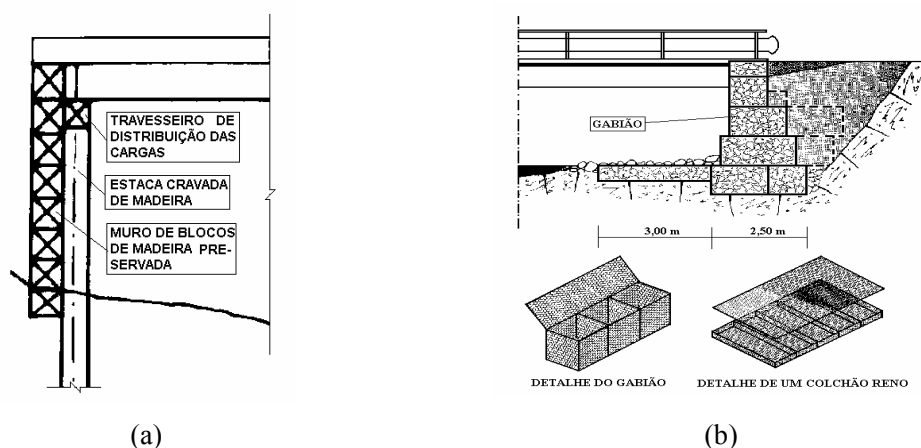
(a) Fundação em estaca com muro de contenção em madeira preservada; (b) Fundação sobre muro de gabiões.
